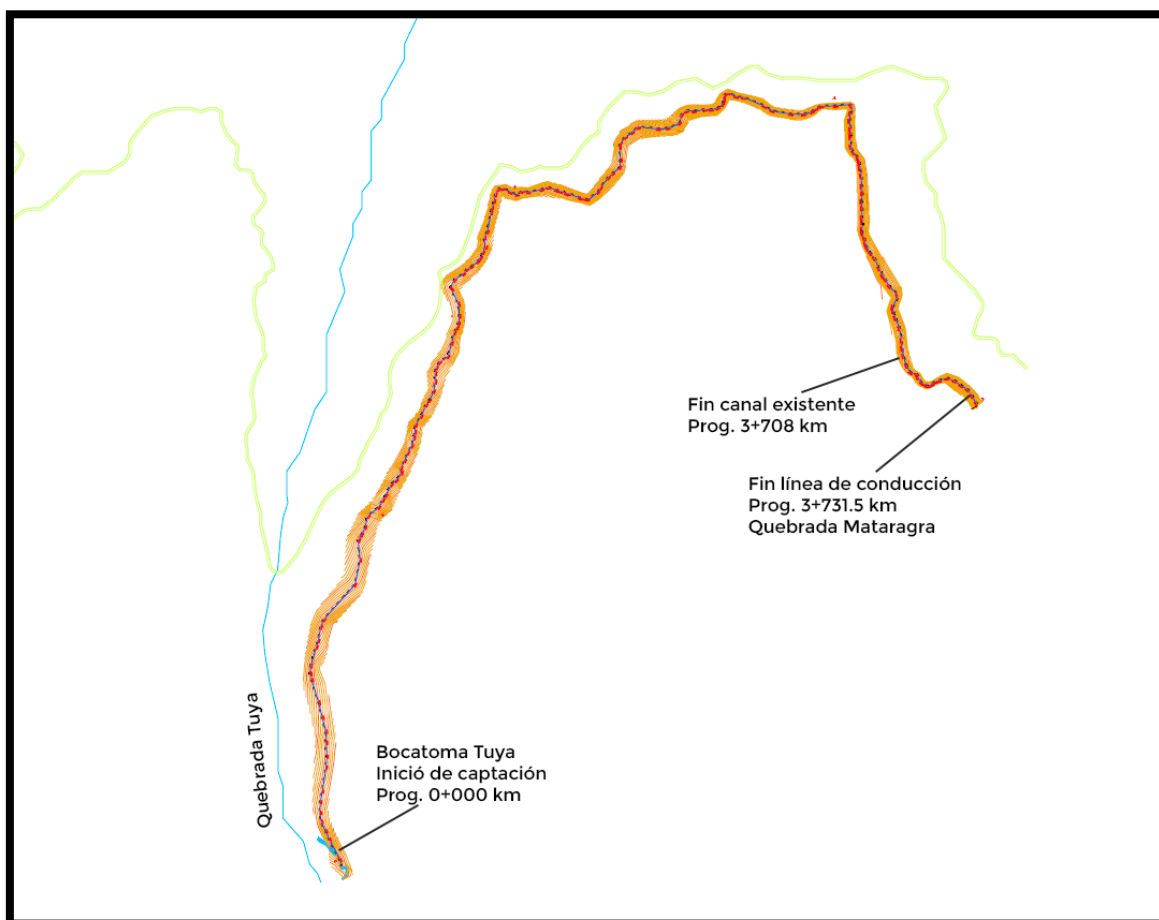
Vista en planta de la topografía del Canal (Elaboración propia 2022).
